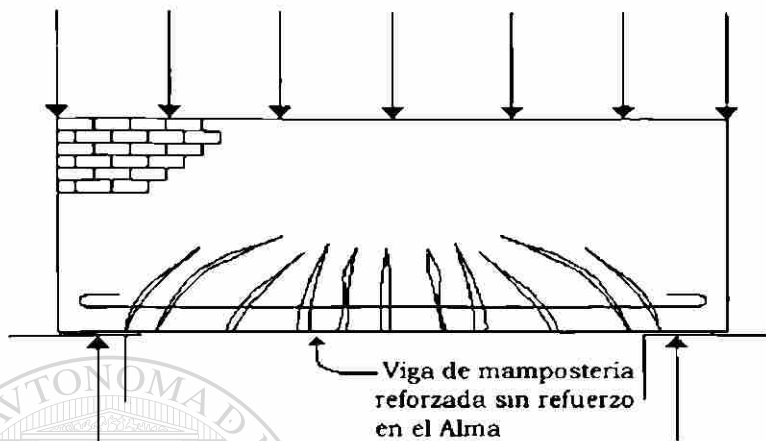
Analogía de arco para vigas de mampostería reforzada sin refuerzo en el alma.
